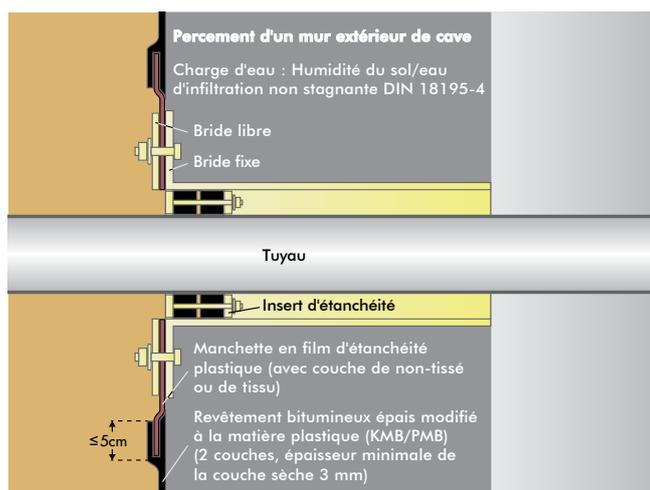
Fixation du KMB sur la construction avec bride libre-fixe [11]
